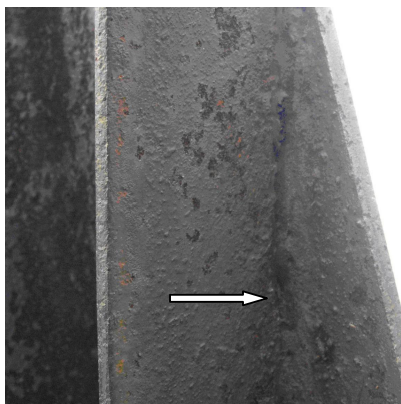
Состояние косыночной части угловой опоры №81 стойка 3 ВЛ 110 кВ «ЗайГРЭС - Каргали» (стрелкой показана сквозное поражение сварного шва щелевой коррозией активизируемой стекающей с опоры дождевой влагой)
